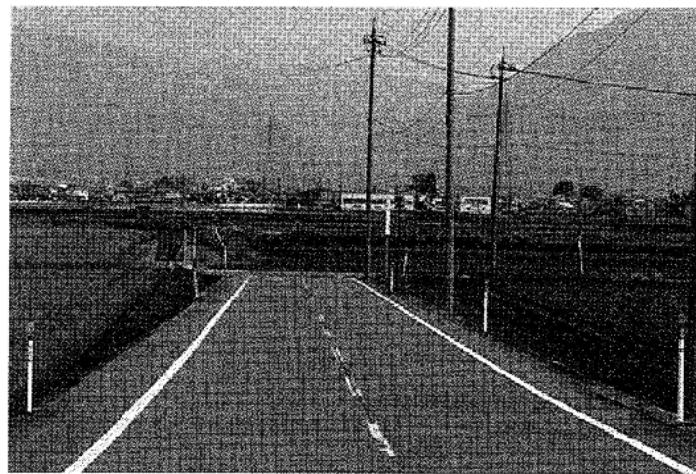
大野の試験舗装の施工場所状況(a タイプ)
